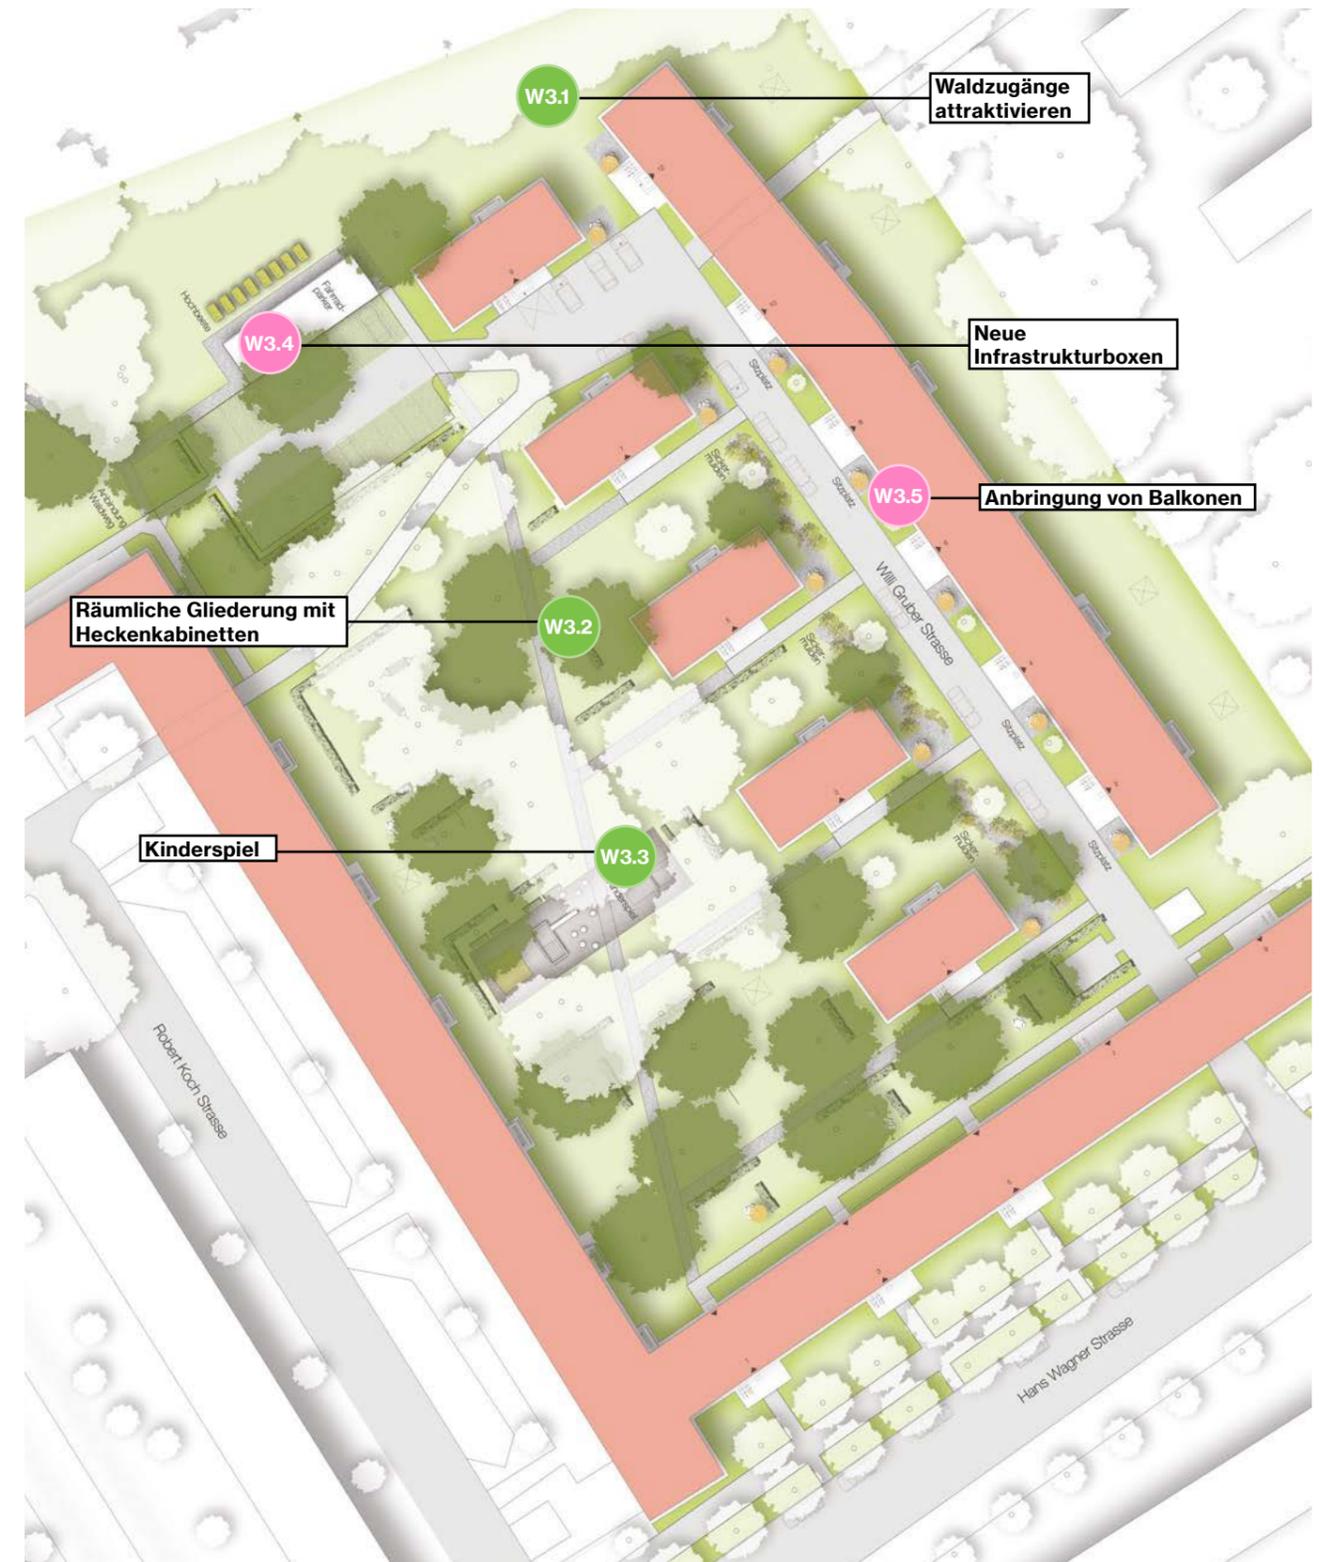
Detailplan Prototyp Willi-Gruber-Straße, Darstellung: DnD Landschaftsplanung
